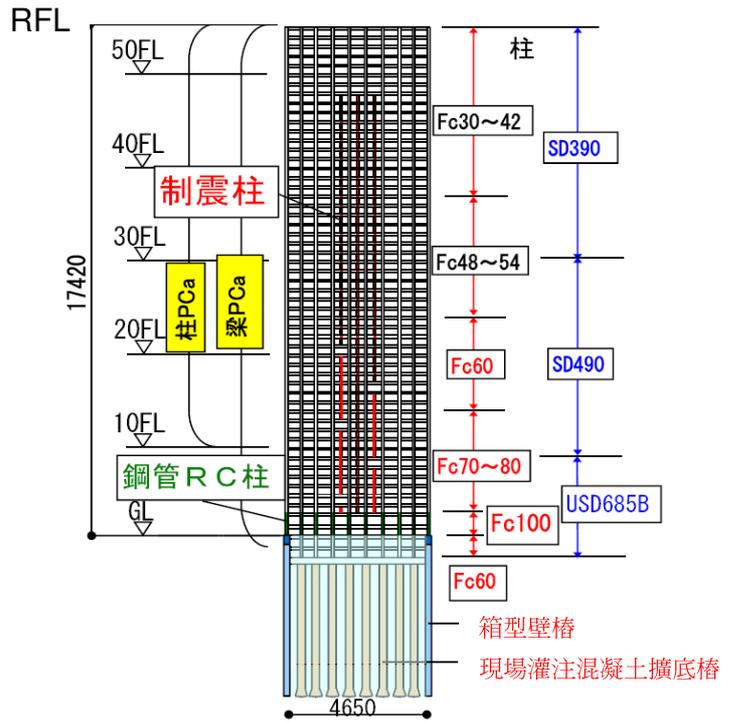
典型的New Rc結構平面圖 (資料來源：文獻1)
